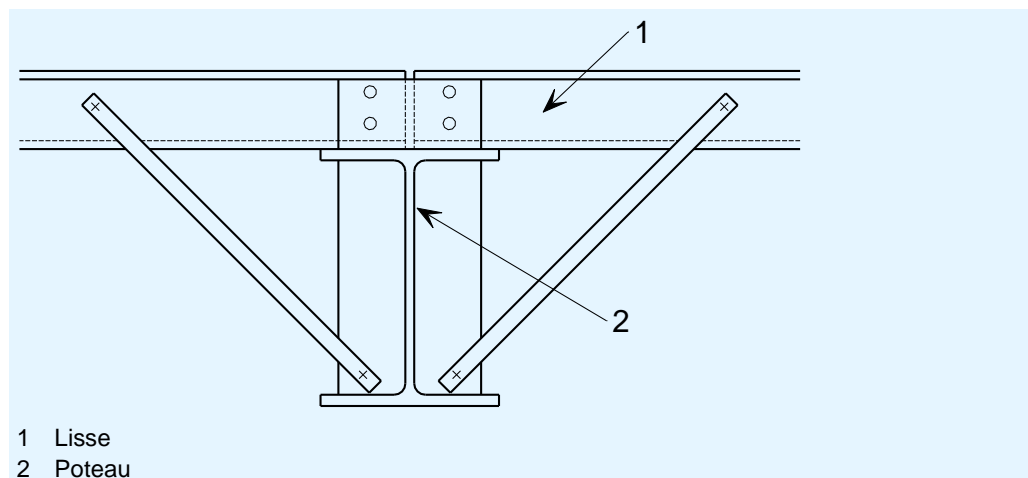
Détail typique de jarret avec un bracon de poteau
